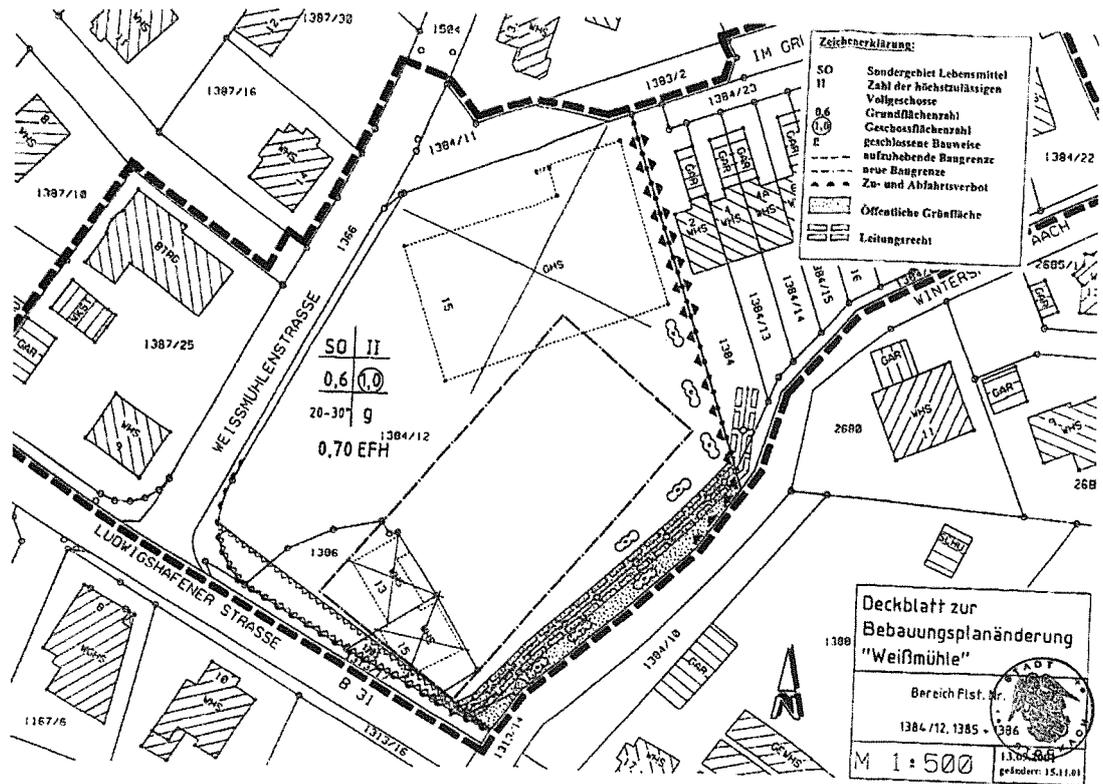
Bebauungsplan 2. Änderung "Weißmühle", rechtsverbindlich seit dem 26.03.02
